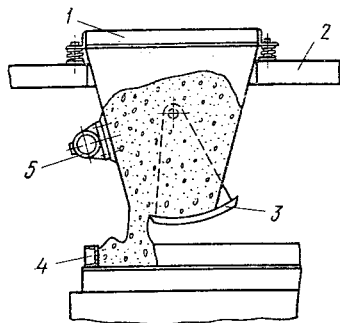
Схема выдачи бетонной смеси из бетонораздатчика:
